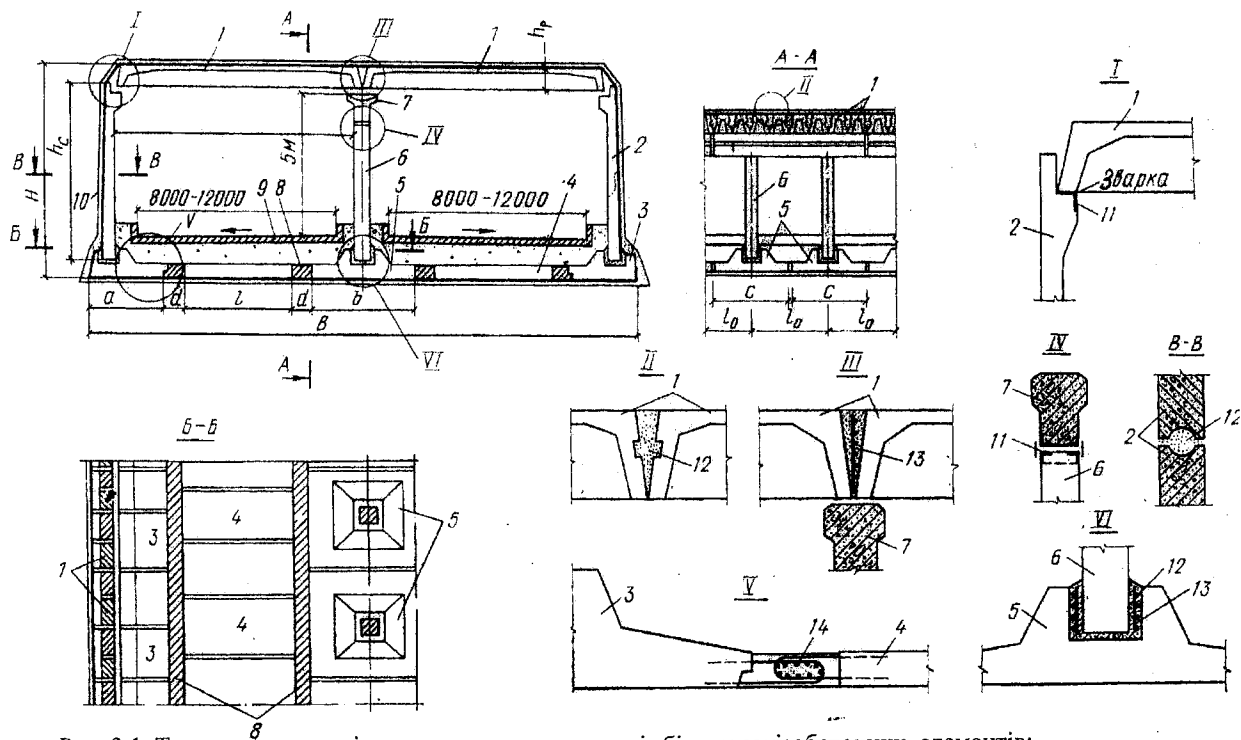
Типова конструкція транспортного тунелю зі збірних залізобетонних елементів:
